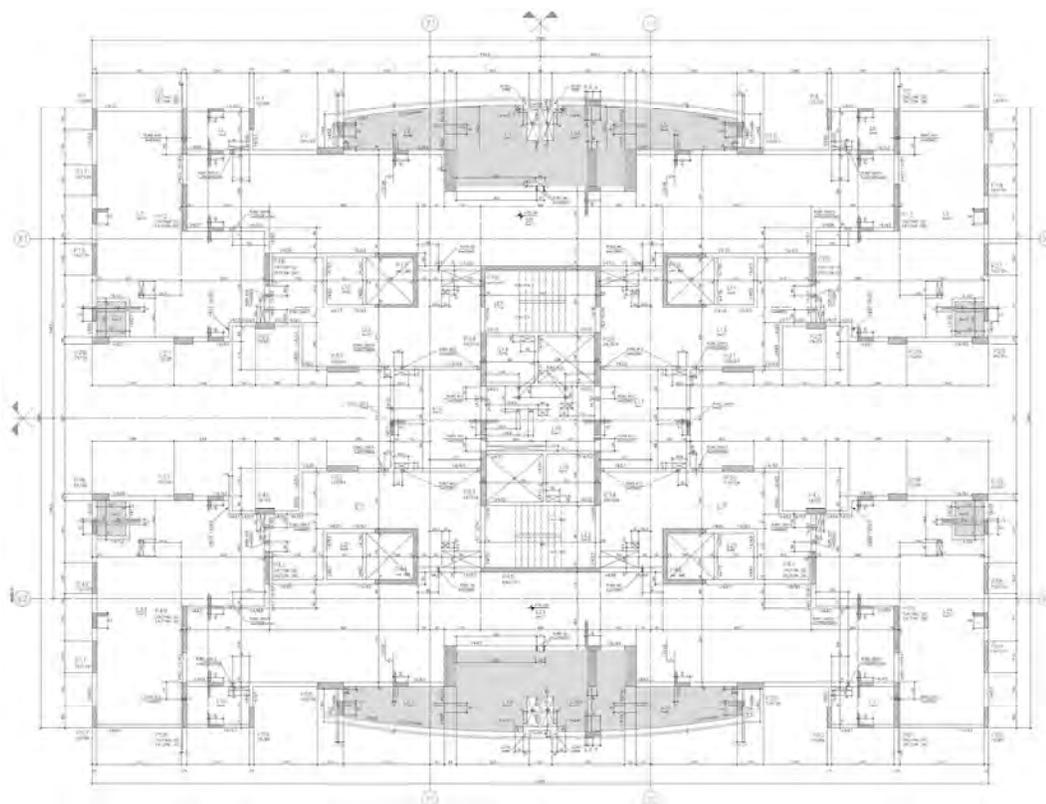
Planta do pavimento tipo das Torres Horizonte e Mirante.
